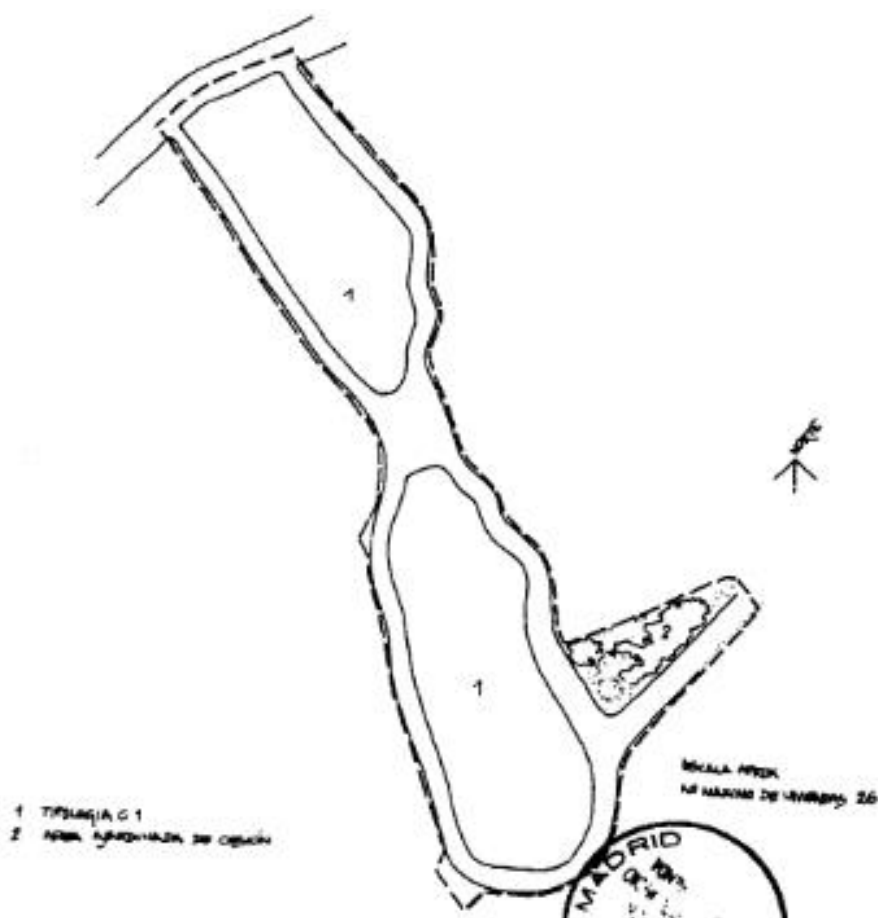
UASU-2. Matalavieja. Planeamiento General Vigente (NNSS de 1985).
